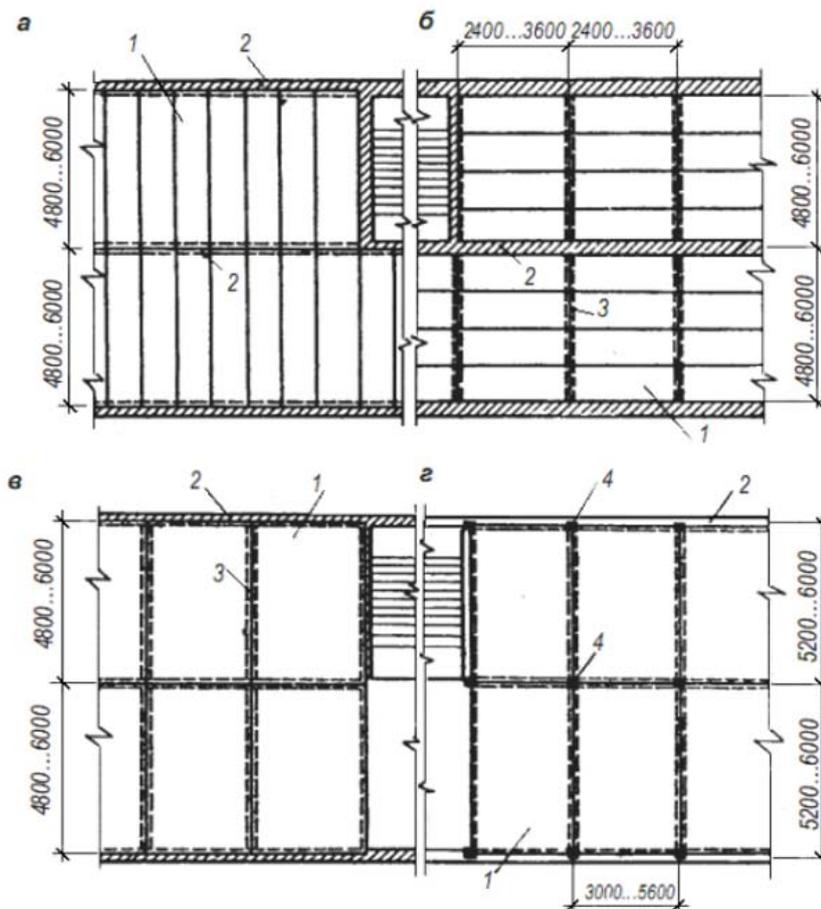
Схеми перекриття із панелей: а – із залізобетонних панелей з опиранням на поздовжні стіни або прогони; б – теж, на поперечні стіни або прогони; в – із панелей, що спираються по контуру; г – із панелей з опиранням на колони по чотирьох кутах; 1 – панелі перекриття; 2 – поздовжні стіни; 3 – поперечні стіни або прогони; 4 – колони
